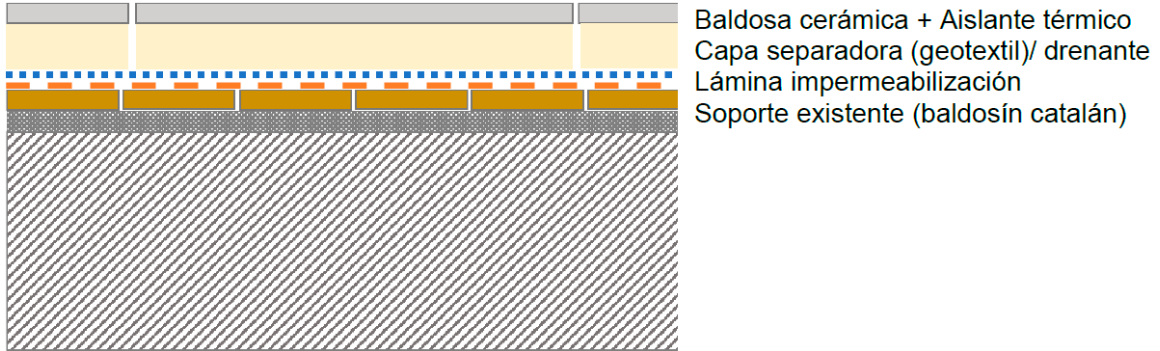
Esquema/ Componentes de la Cubierta invertida con pavimento permeable. Fuente. Estudio multicriterio ROOFTILES
